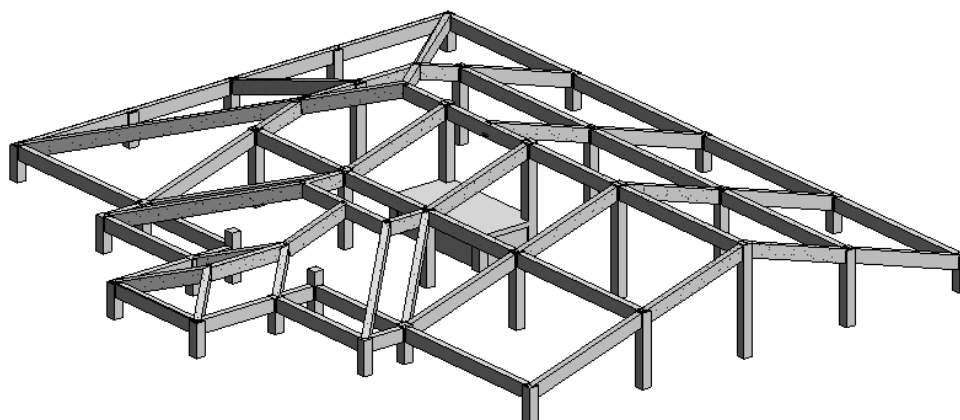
Solução adotada para o suporte da laje da cobertura (localização em Portugal).
